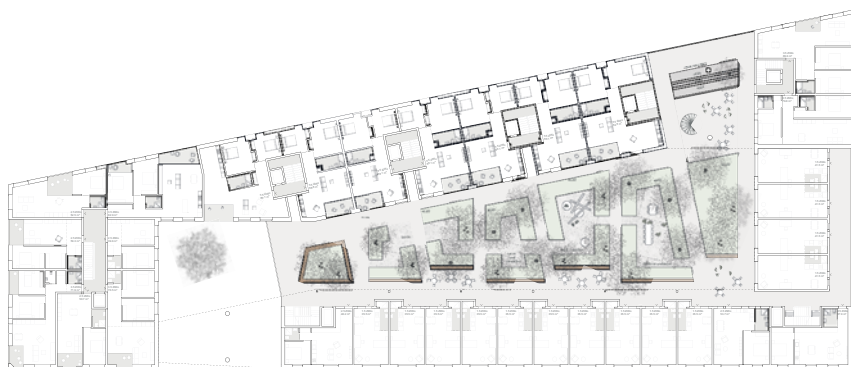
Konzeptioneller Grundriss 1. Obergeschoss mit gemeinschaftlichem Innenhof
